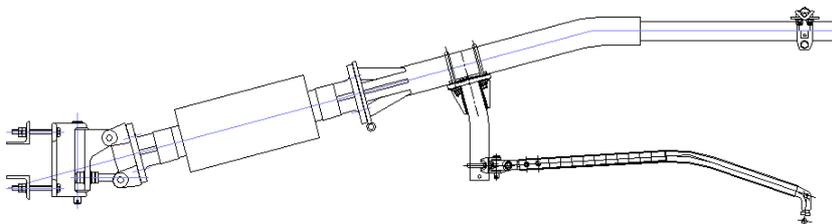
Montage type caténaire en tunnel / Tipologico catenaria nel tunnel
